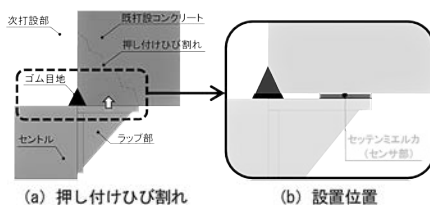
押し付けひび割れとセッテンミエルカ設置位置
